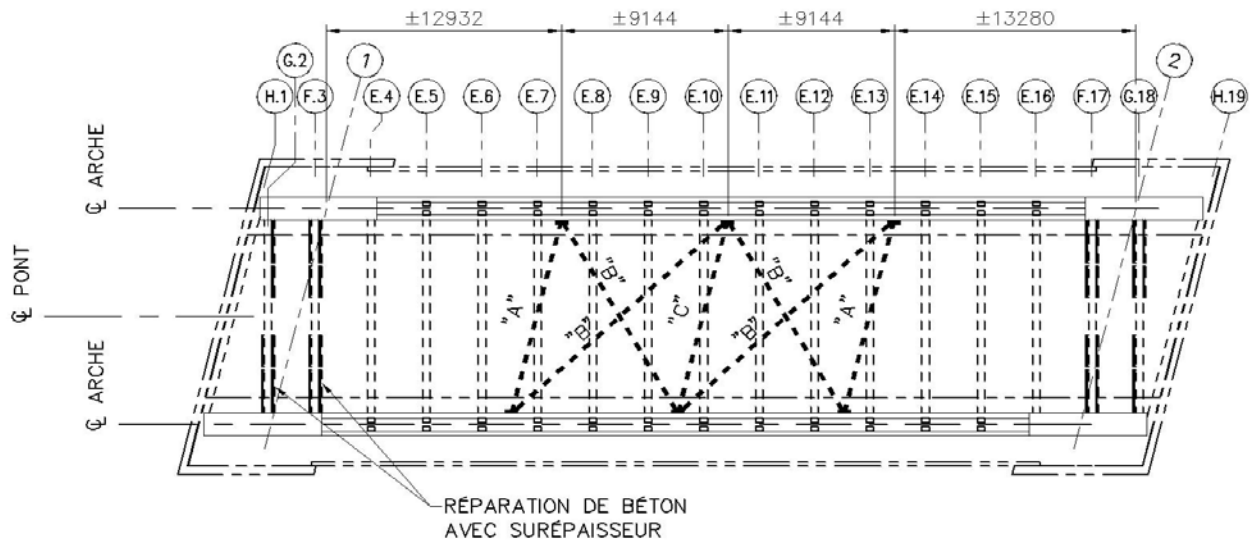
Système de contreventements temporaires et poutres transversales renforcées
